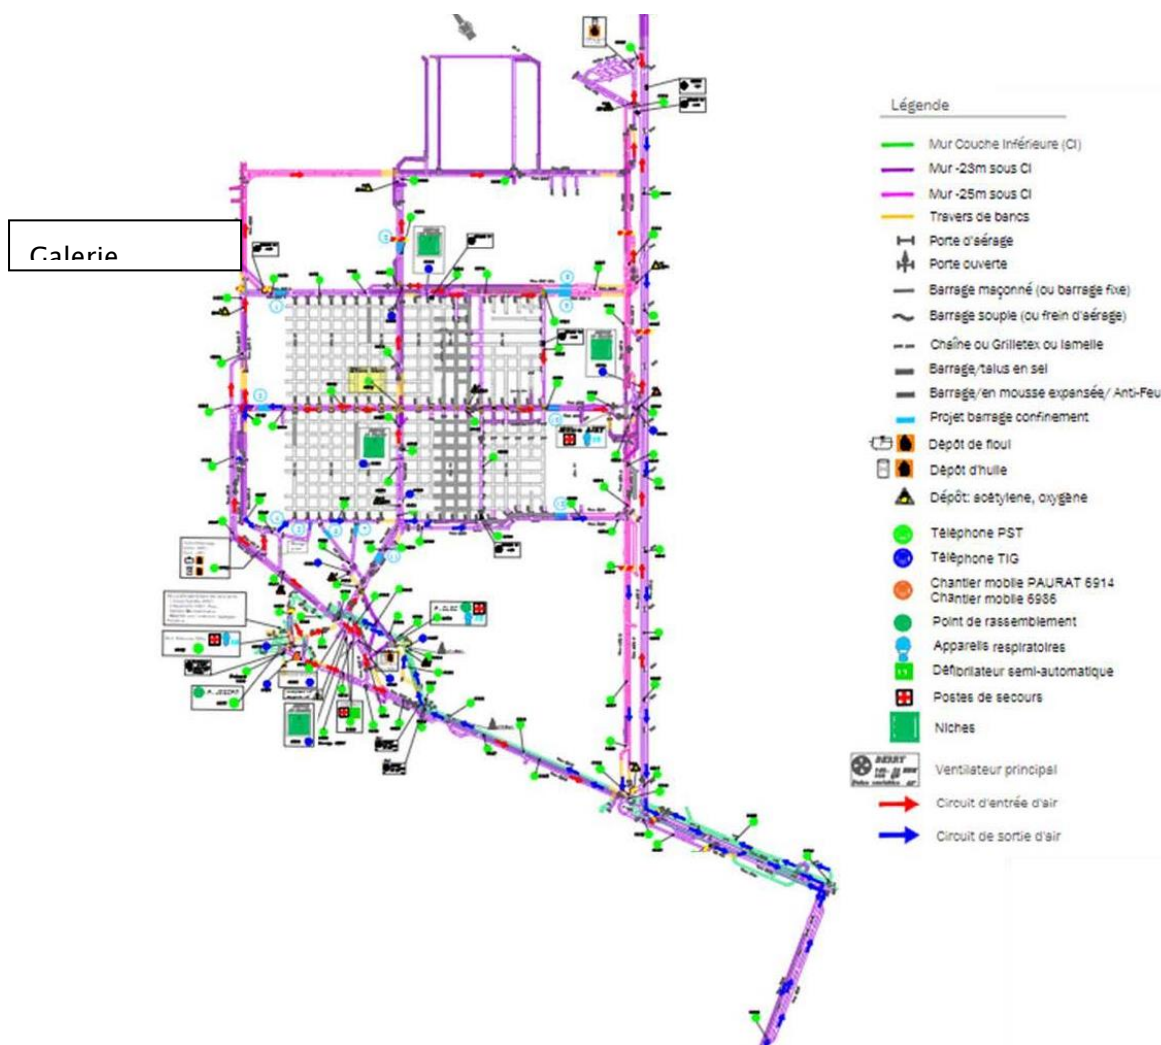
Plan général du fond avec barrières de confinement. Source : dossier)
